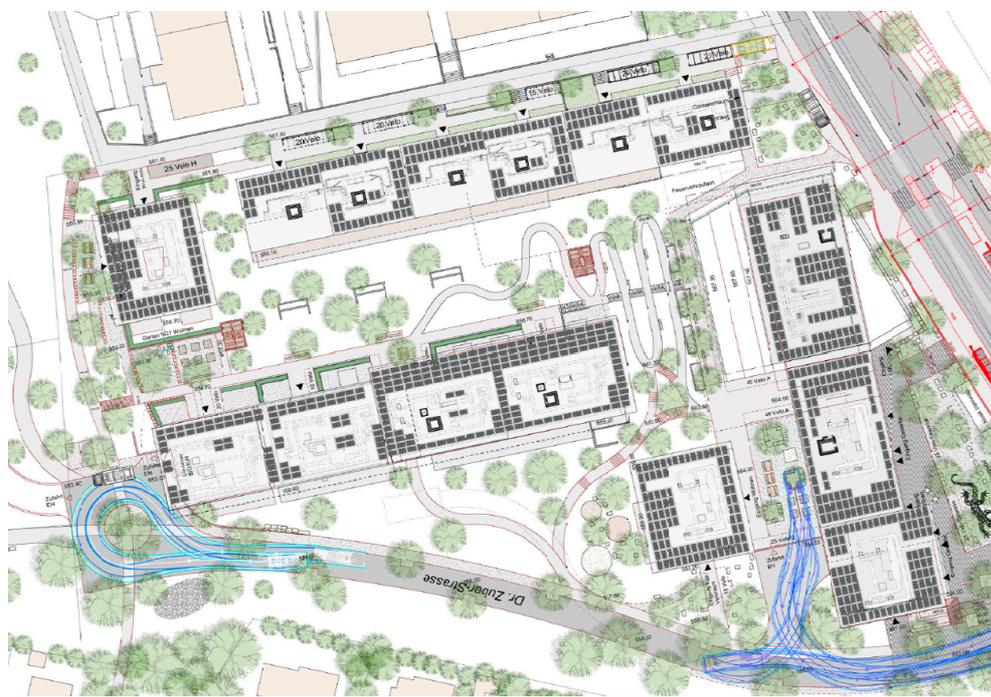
Dachaufsicht [Burkhalter Architekten AG]
